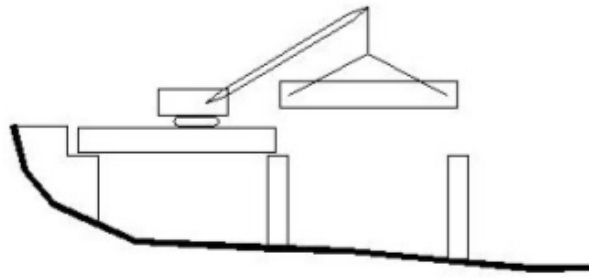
Монтиране на главни греди на мост над река;
